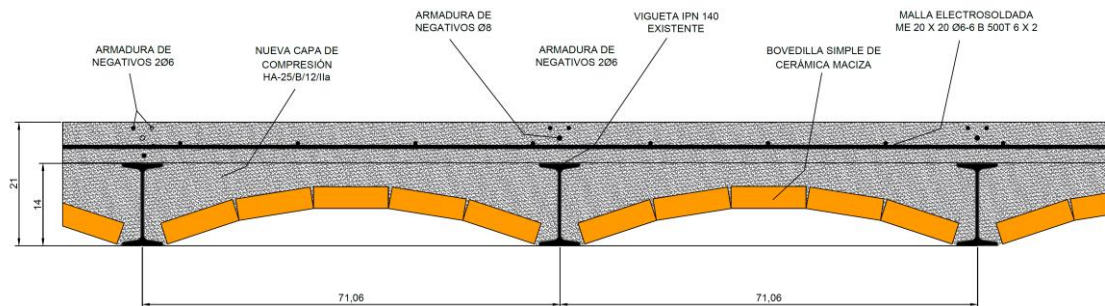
Sección transversal de la alternativa 1 (Fuente: elaboración propia)
